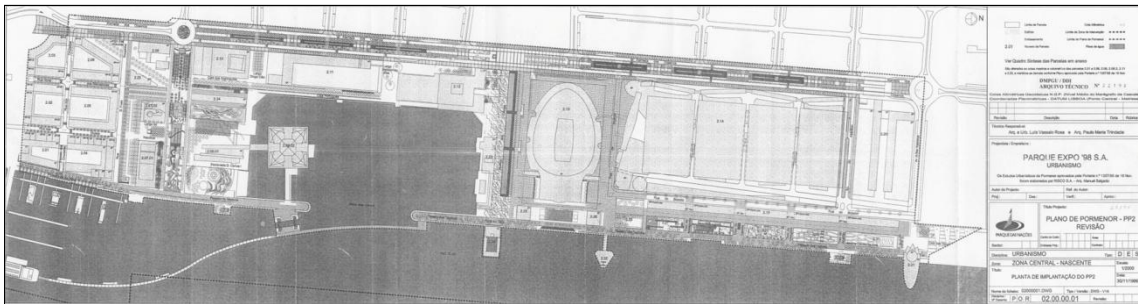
Planta do Plano de Pormenor n.º2: Zona do Recinto da Expo 98
